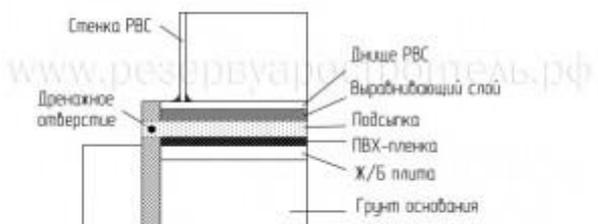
(г) – Фундамент РВС в виде подпорной стенки
